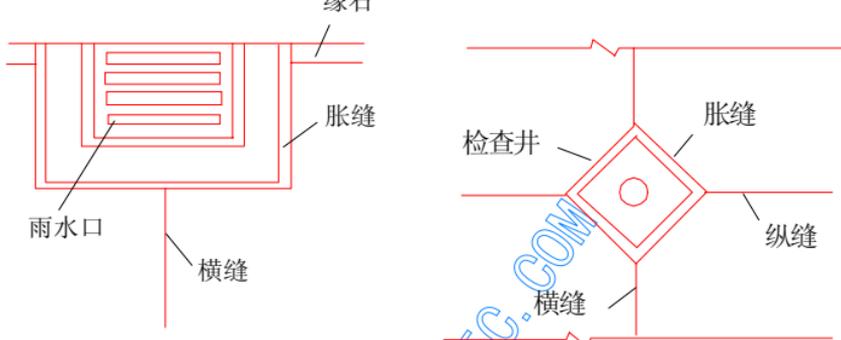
混凝土板中雨水口和检查井的布置
